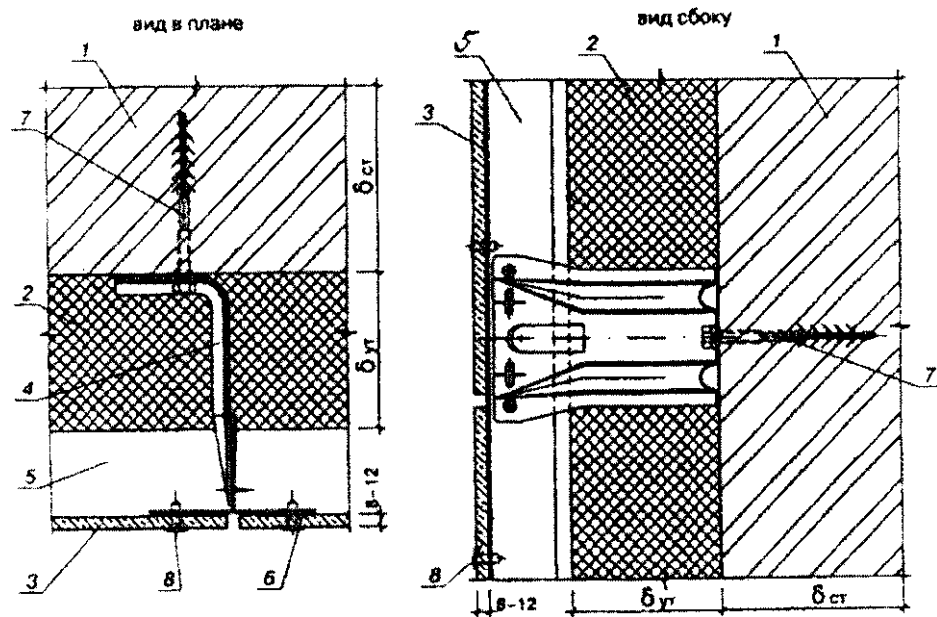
Система утеплення стін із захисним екраном (стеклофібробетона плити); 1 - утеплювачі стіни, 2 - утеплювач, 3 - стеклофібробетона плити, 4 - кріпильний елемент, 5 - вентиляований повітряний зазор, 6 - вертикальний профіль з корозійно-стійкого металу, 7 - дюбель, 8 - самонарізні гвинти або заклепки
